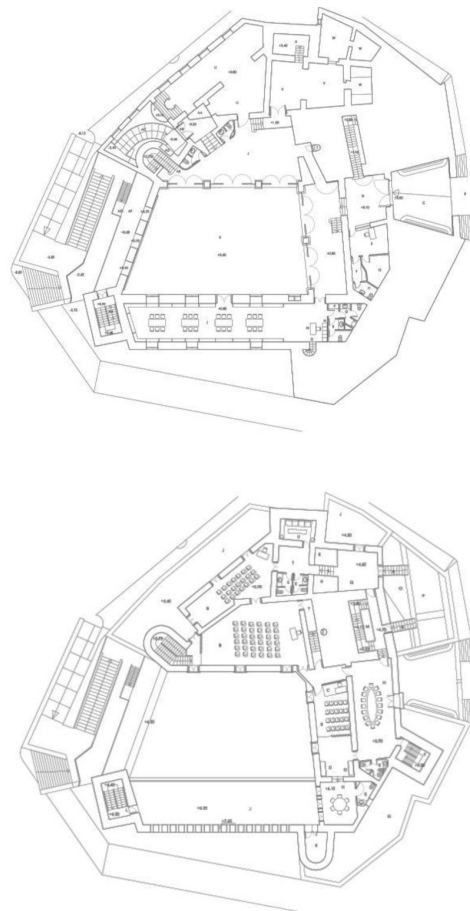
Levantamiento gráfico actual del castillo de Bétera. Plantas de arriba abajo: planta baja, planta primera. (Imagen de archivo de la UPV).
